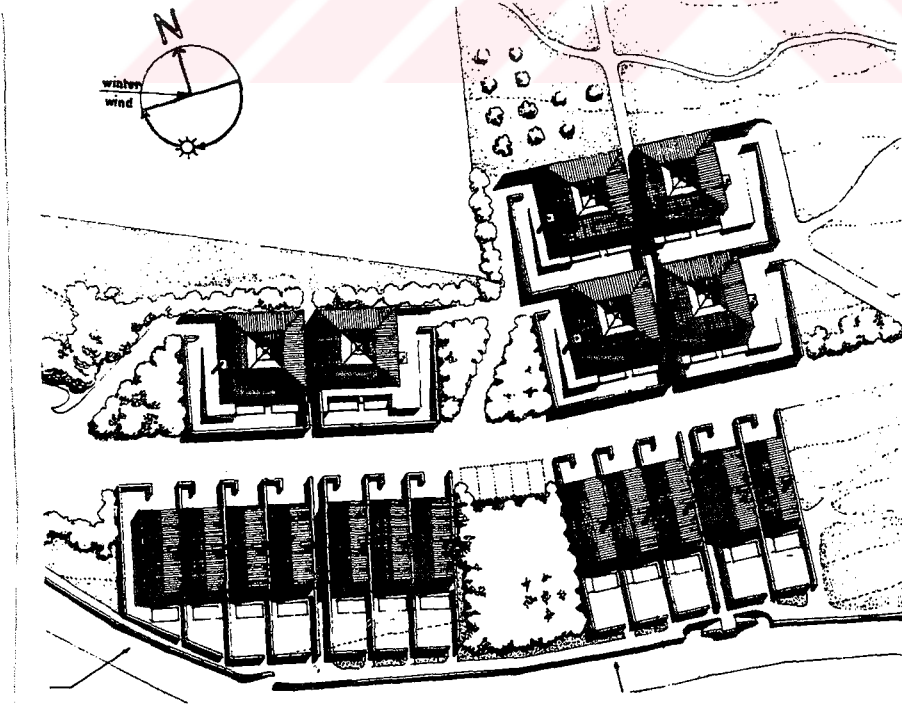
Montbord'daki toplu konutun vaziyet planı
